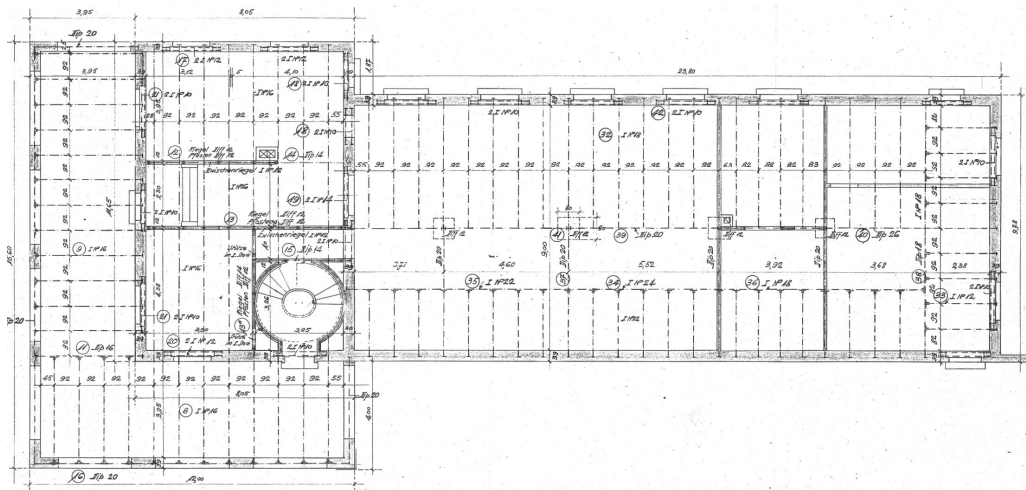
Grundriss EG, Bestandsplan
